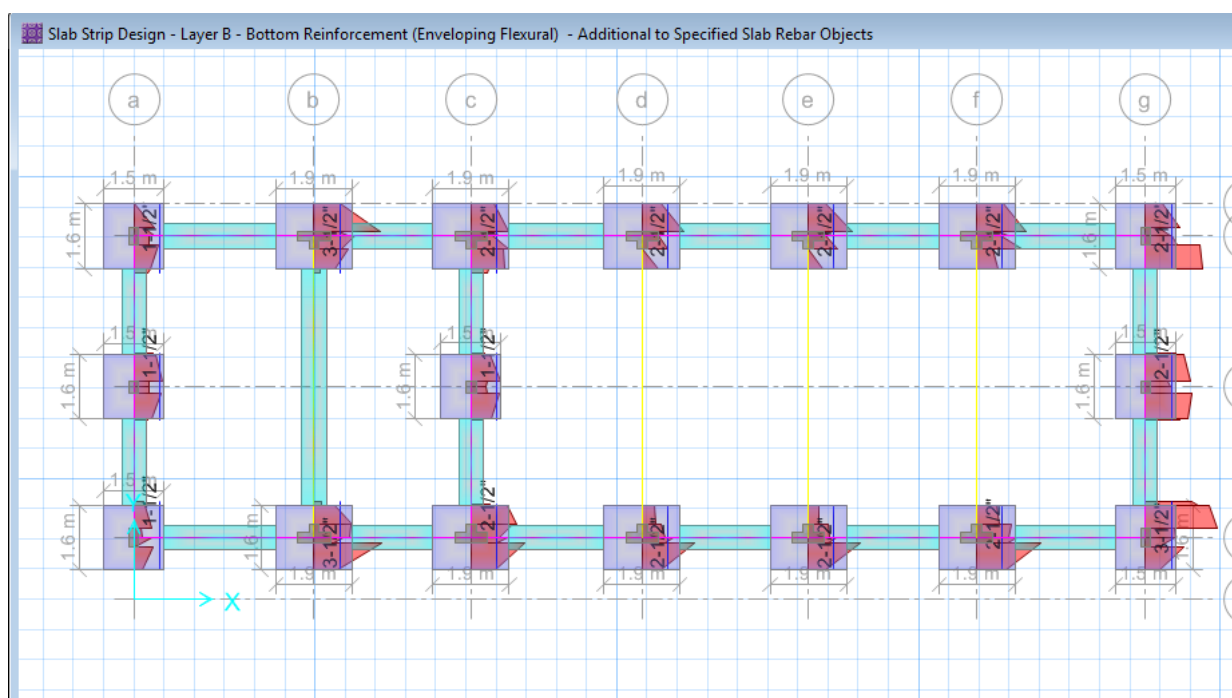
Refuerzo en cm² de cimentación Módulo IV
